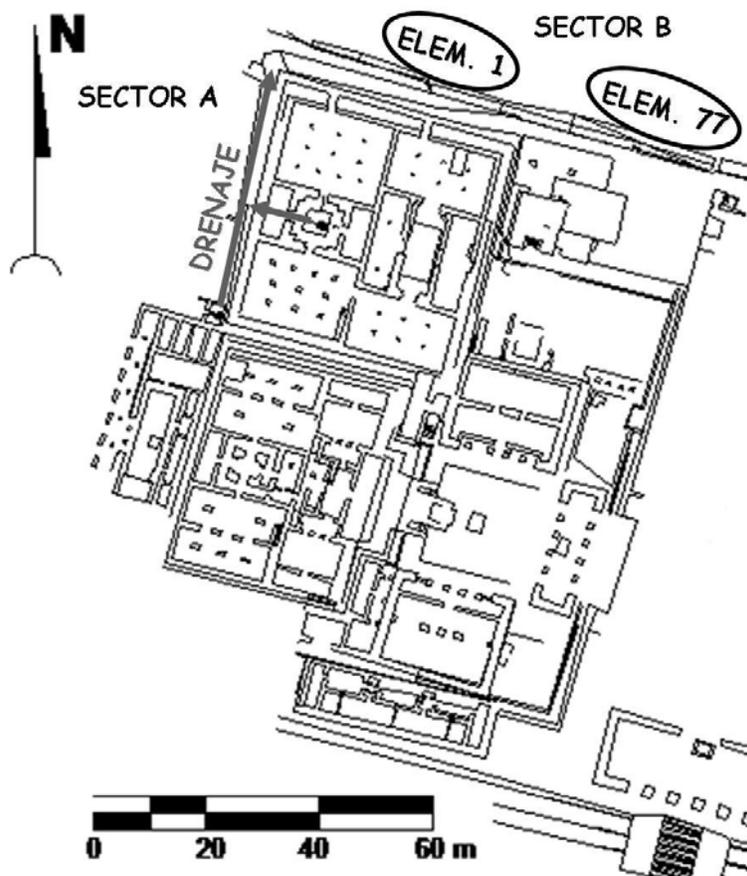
Plano con la localización de los Elementos 1 y 77 del Sector B.
